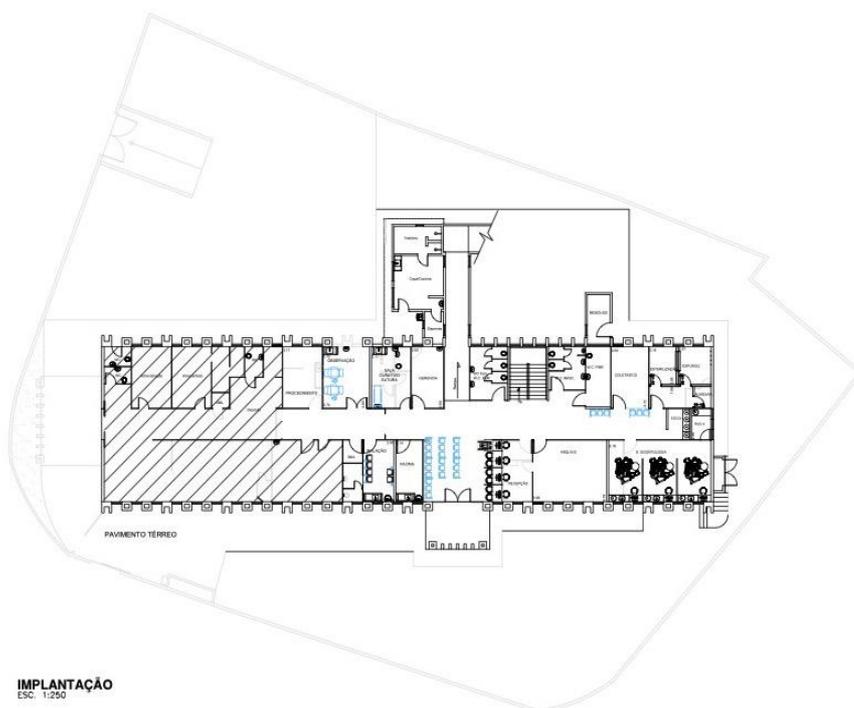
US Centreville. Planta do primeiro pavimento, mostrando em vermelho a área que será removida e em azul a que será construída.
